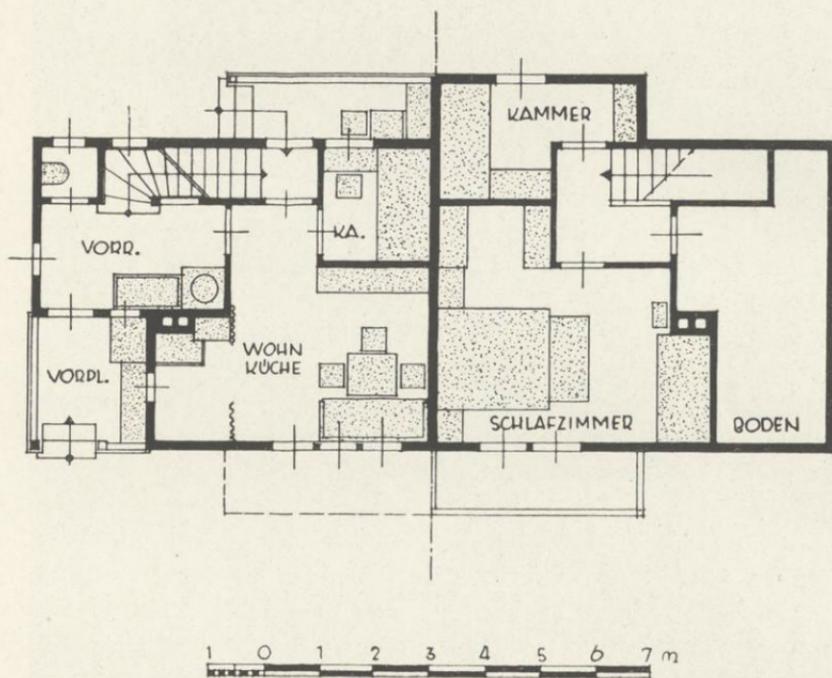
Raumausteilung (Grundriß) des Siedlungshauses St. Peter-Linz Type C
